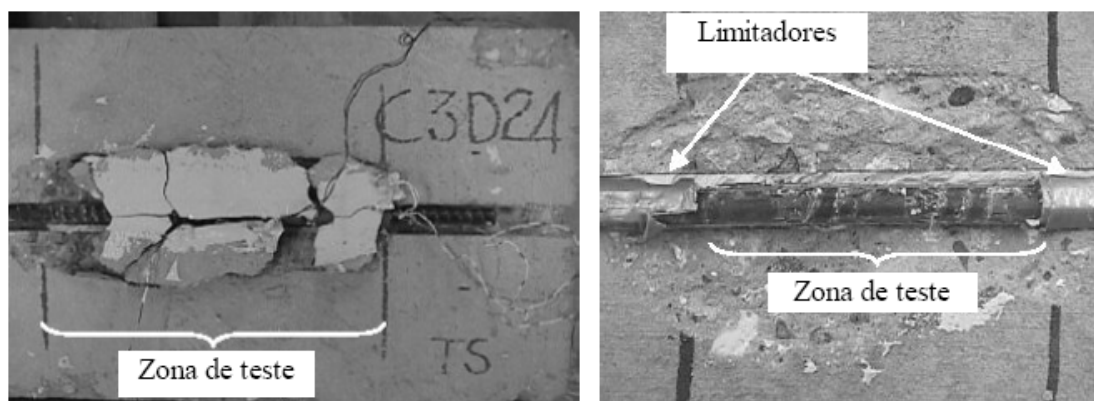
Exemplos com ruptura por fendilhamento no epóxi e fissuração no concreto (De Lorenzis & Nanni, 2002, com adaptações)
